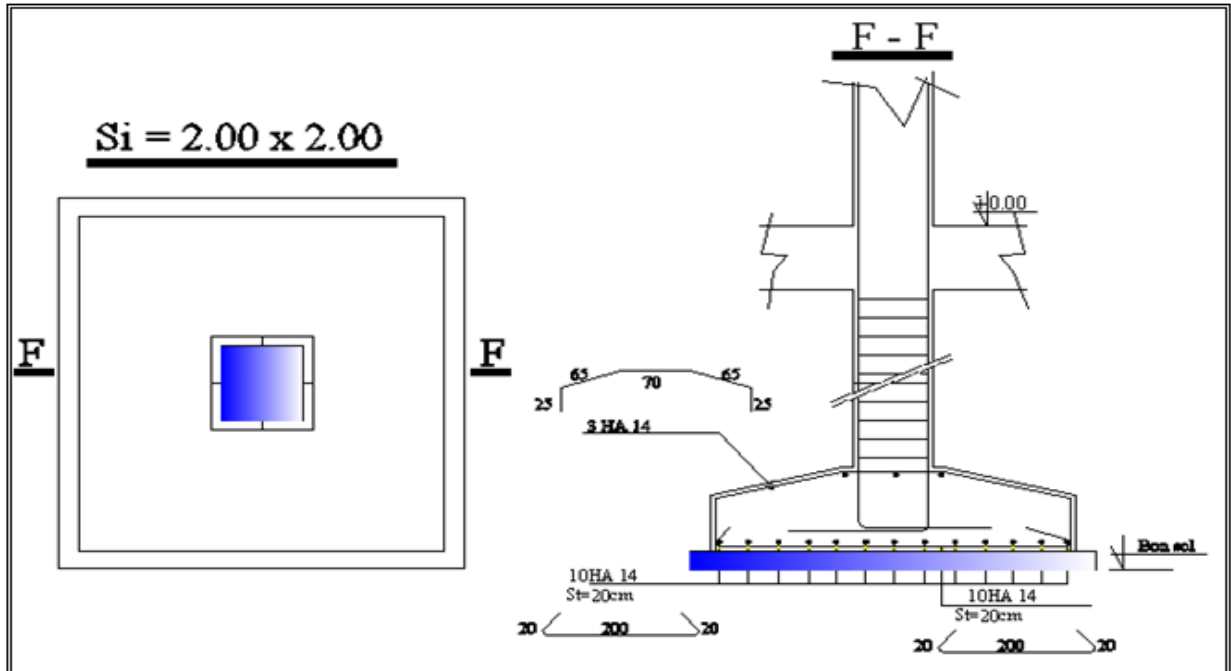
schéma de ferrailage d'une semelle isolée
